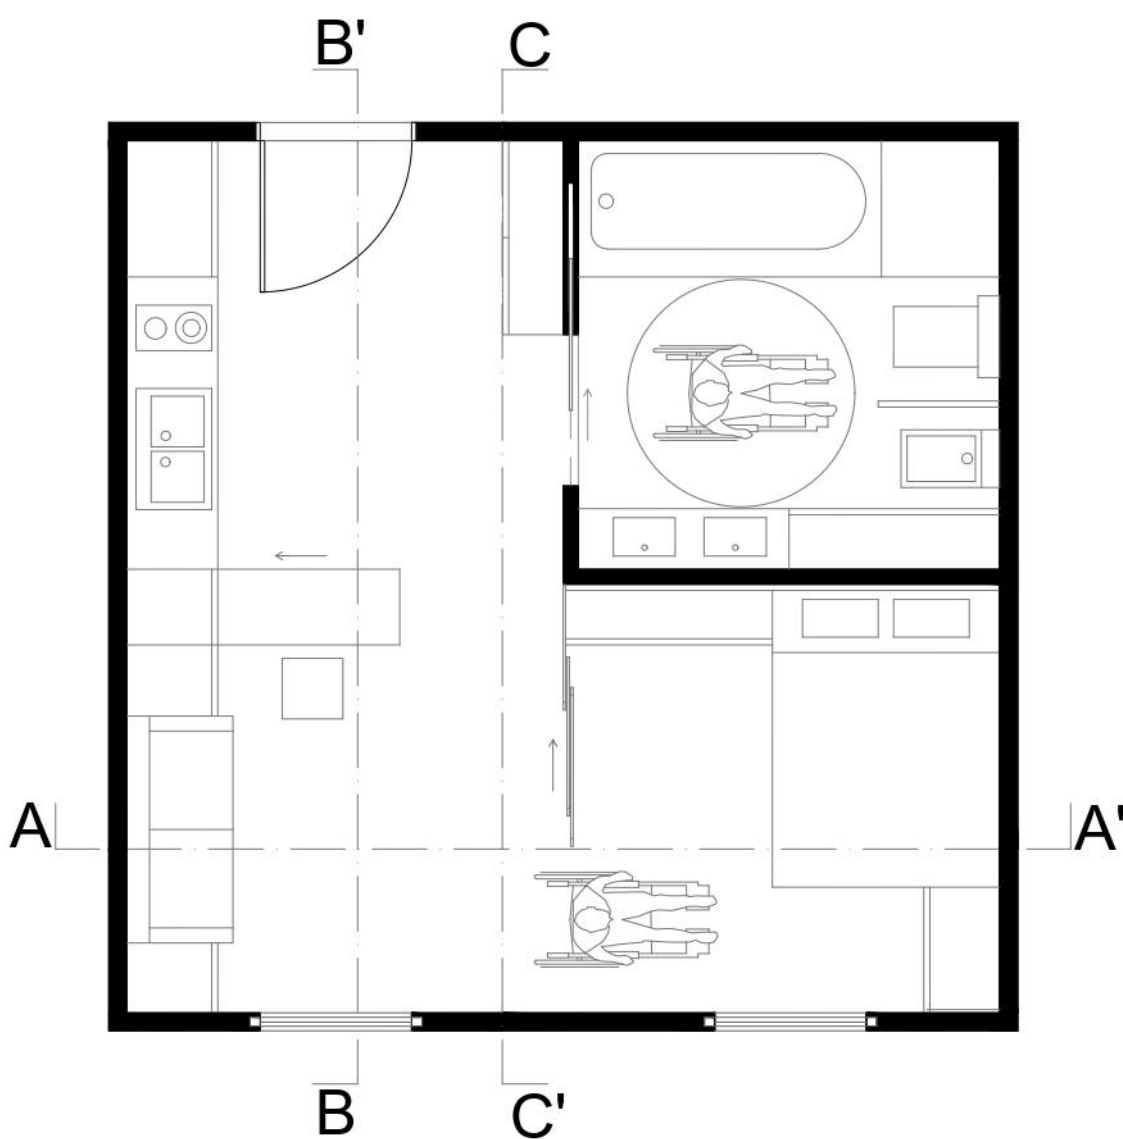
Planta do módulo 2 (Ferreira, 2020)
